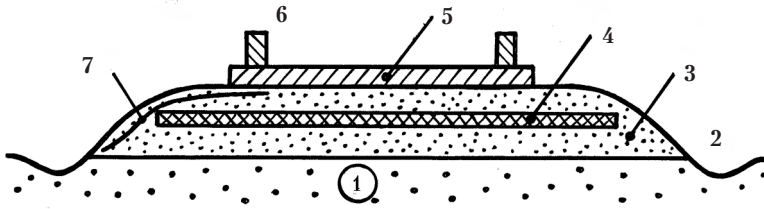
Принцип устройства плавающего фундамента. 1 – материковый грунт, 2 – дренаж, 3 – песчаная подушка (песчаный фундамент), 4 – слой экструзионного пенополистирола (или пенобетона, пеностекла, керамзита и т. п.), 5 – фундаментная плита (или лента, кольцо), 6 – коколь, 7 – гидроизоляция утеплителя.
